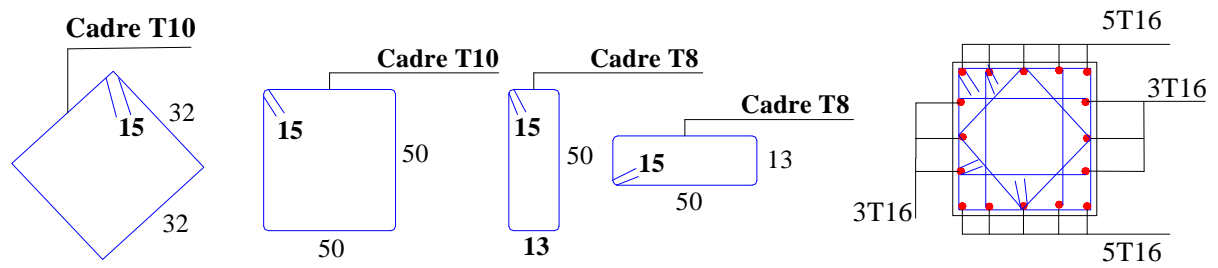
Schéma de ferrailage des poteaux des entres sol 01, 02, 03 et RDC
